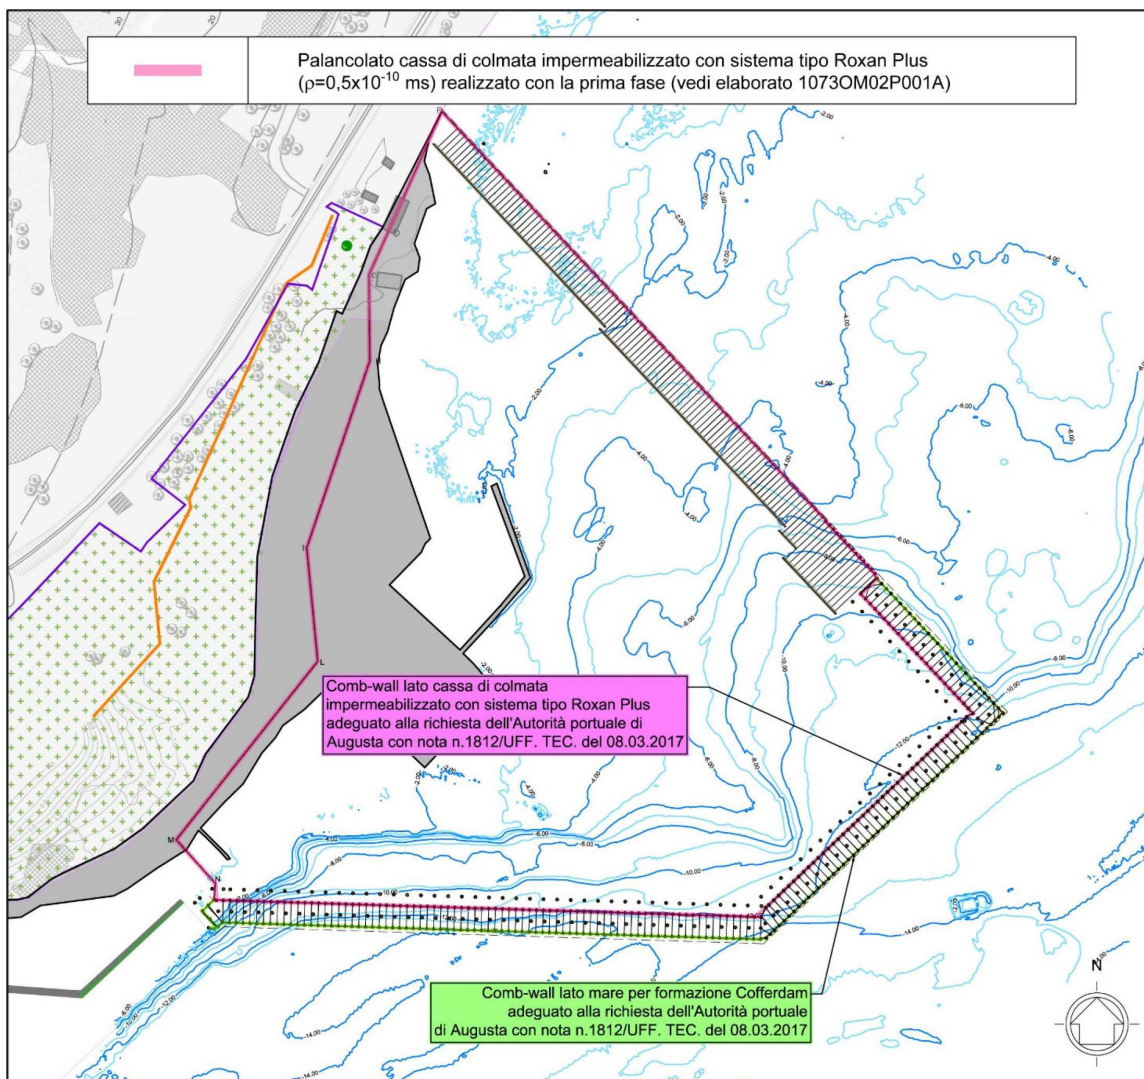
Planimetria progetto adeguato alle disposizioni dell' Autorità Portuale.
